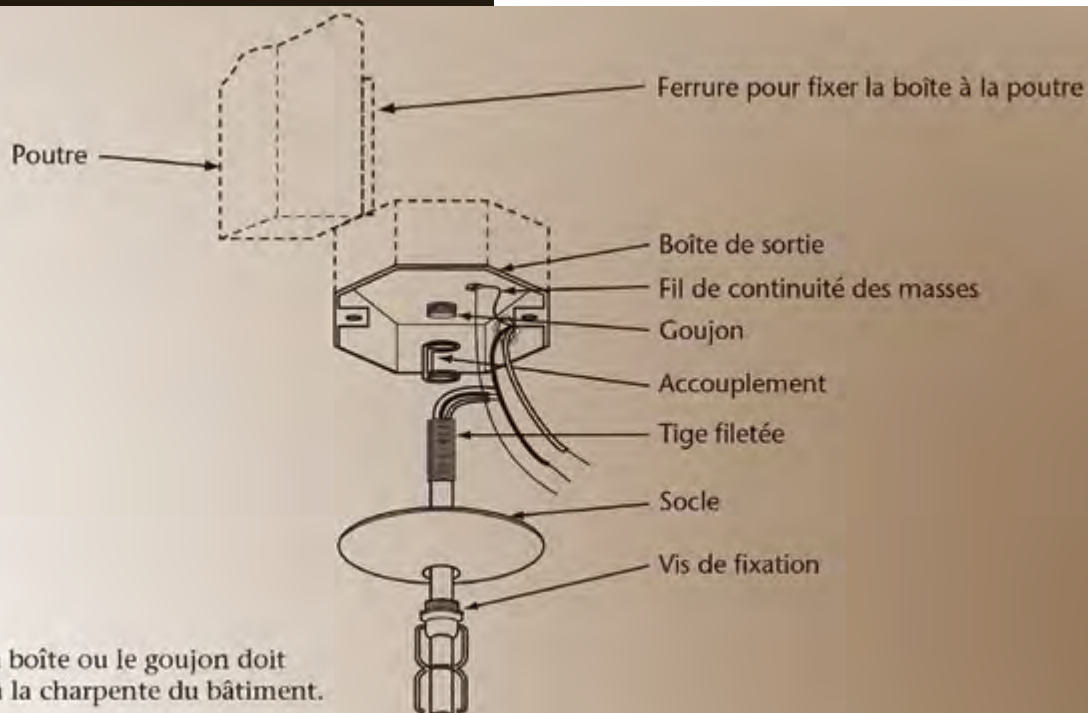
Fixation type d'un luminaire de plafond pesant plus de 23 kg
